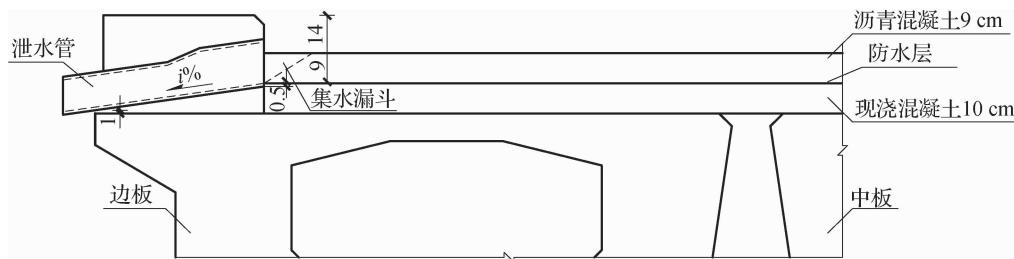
横向泄水管安装示意图(尺寸单位:cm)
